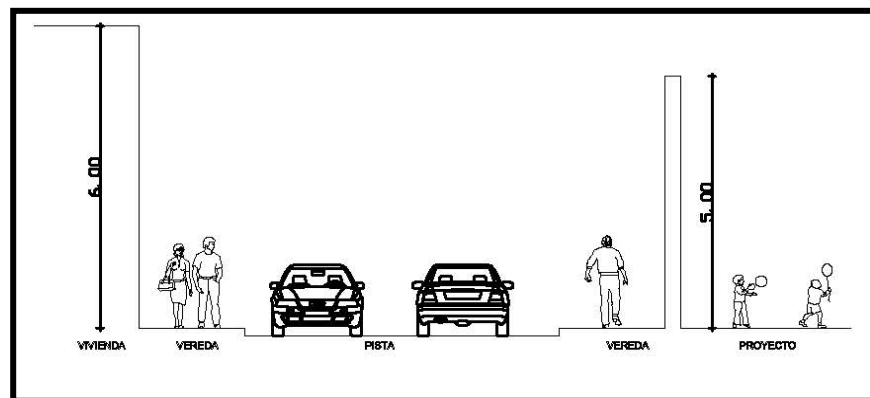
Sección Vial Calle Cerro Los Angeles
